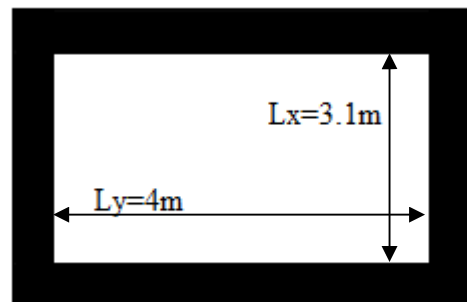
Schéma d'un dalle pleine sur quatre appuis
